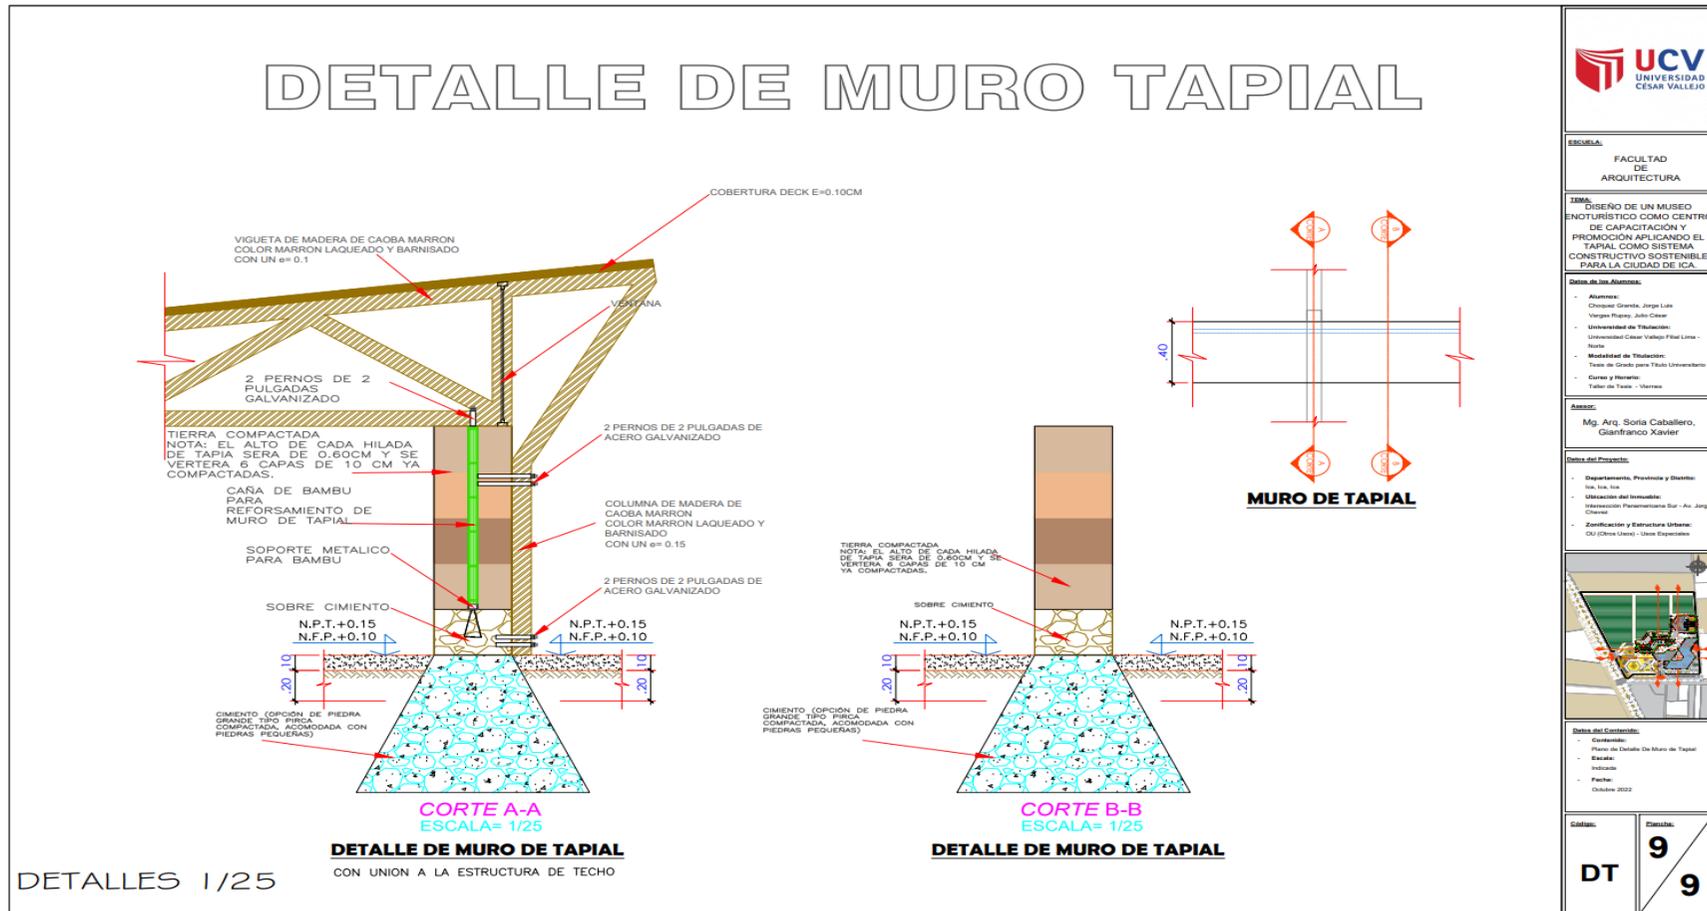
Plano de Detalles Arquitectónicos – Detalle de Sistema Constructivo
